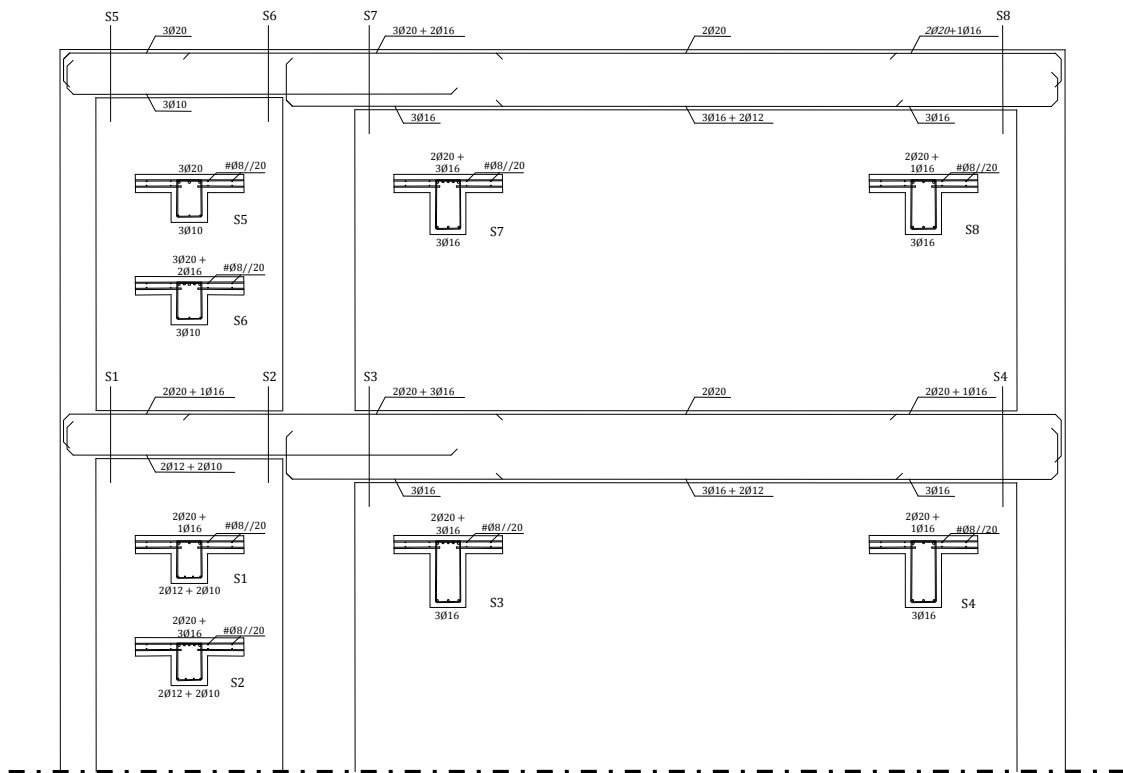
Esquematização das armaduras adotadas nas vigas da estrutura do edifício do caso de estudo.
